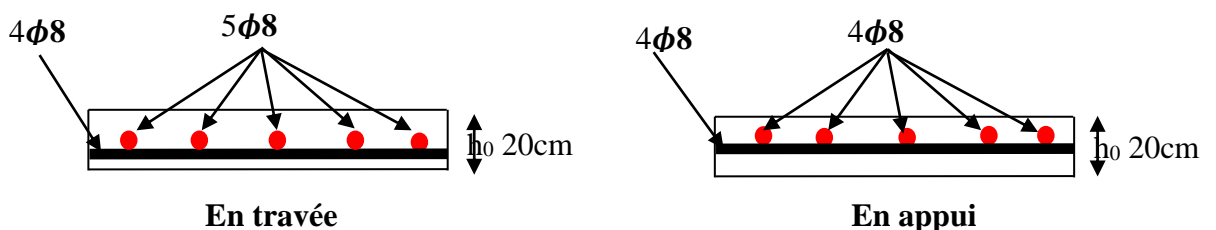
Schémas de ferrailage de la dalle du local machine
